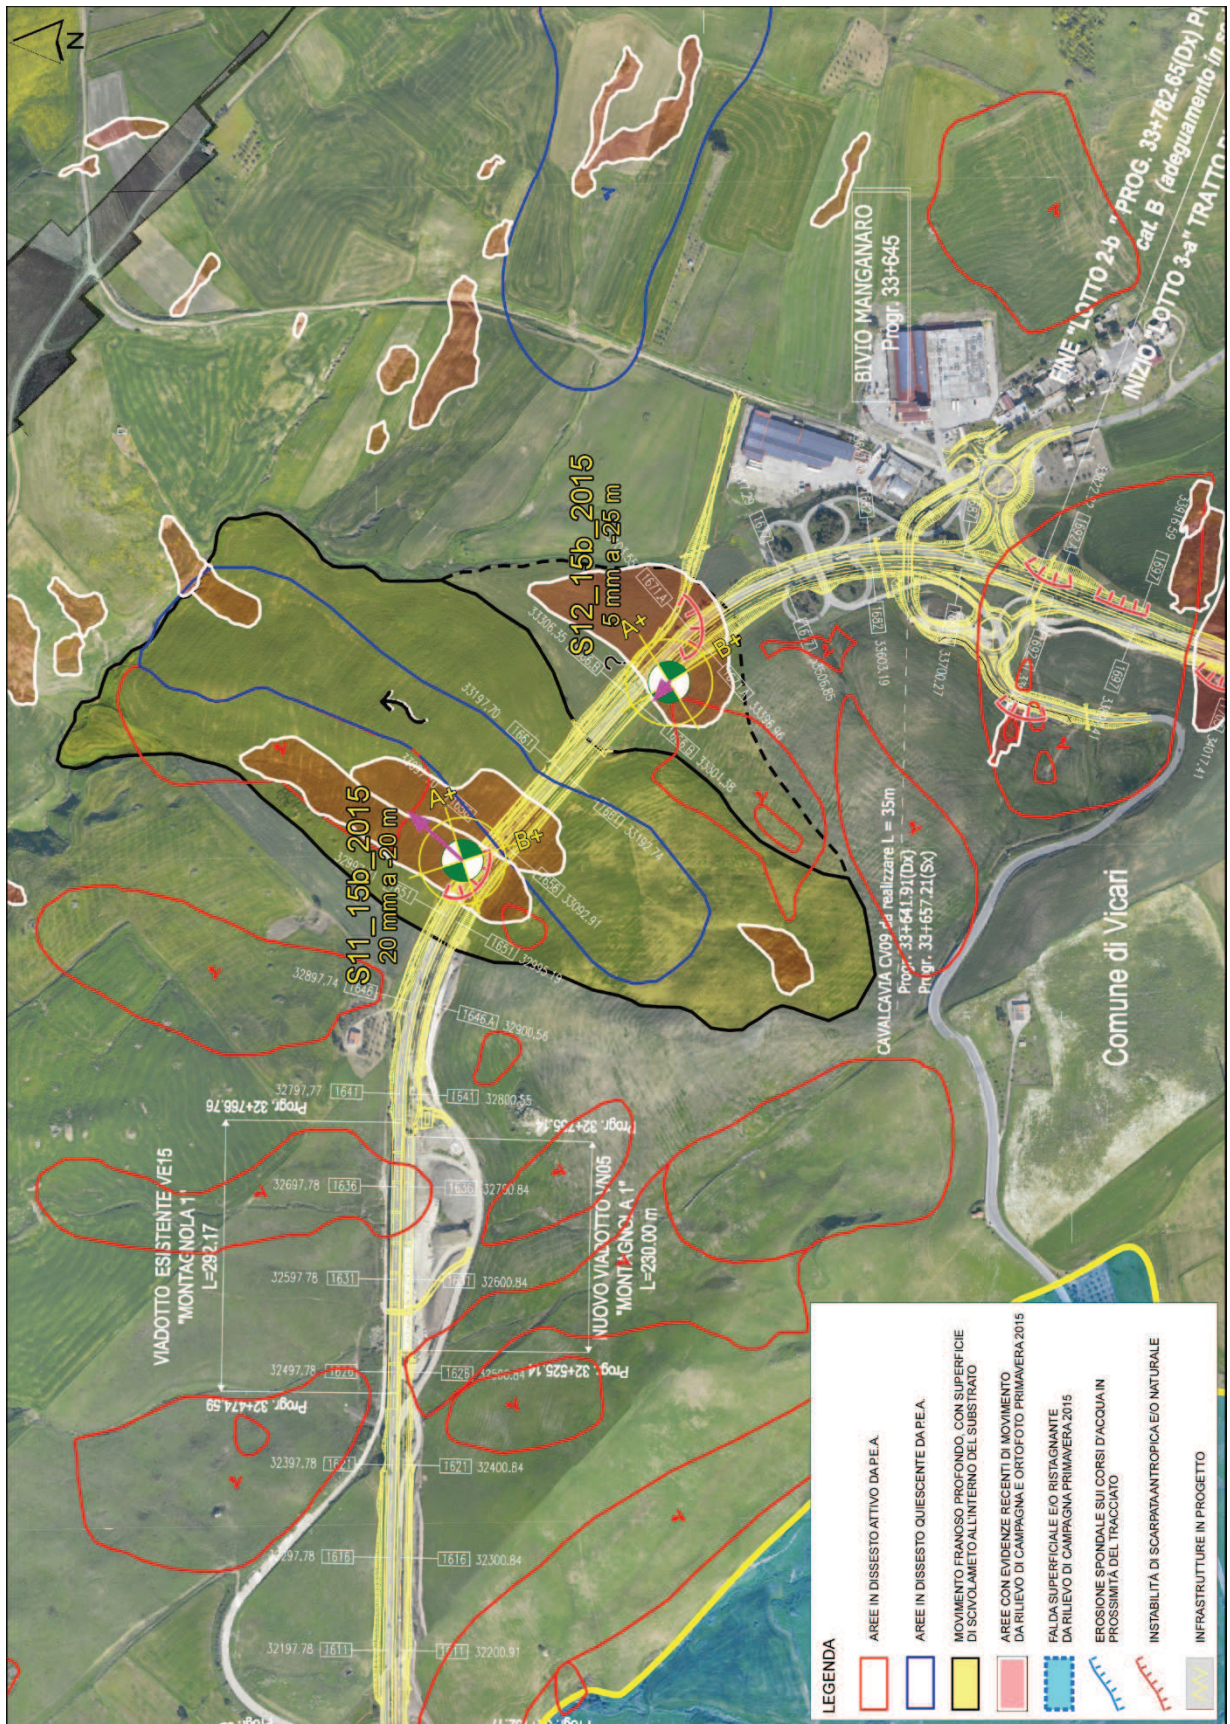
PK 33+077. Individuazione planimetria dell'area in movimento
